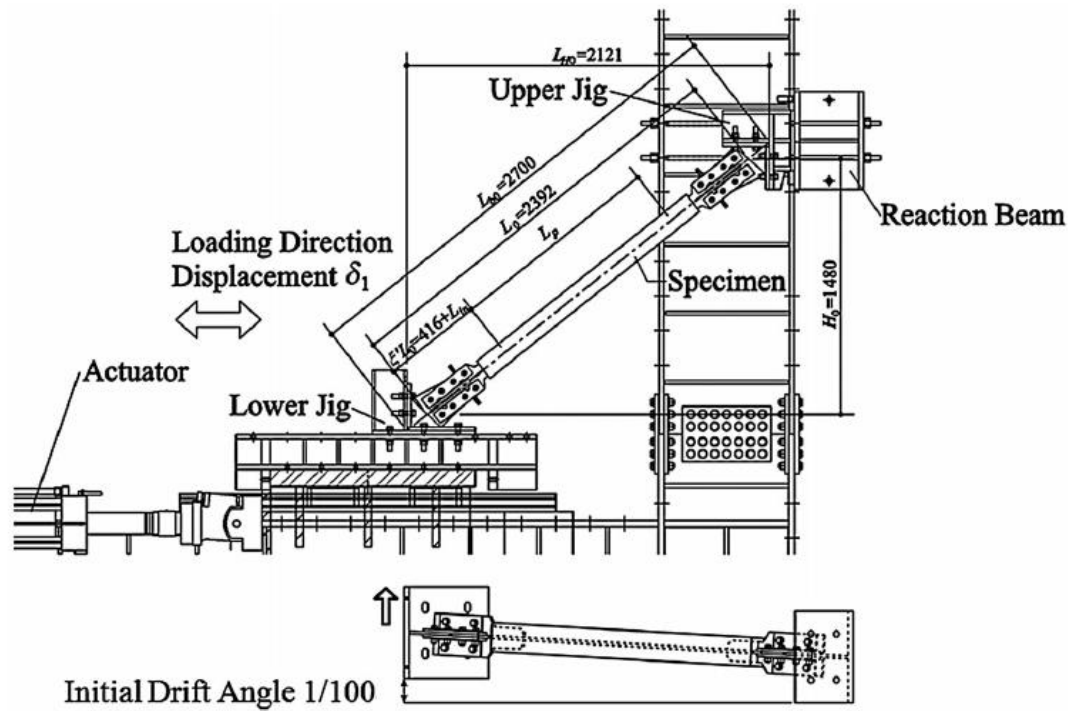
4 Elevación y planta de ensayo de subestructura realizado por Takeuchi et al (2013)
